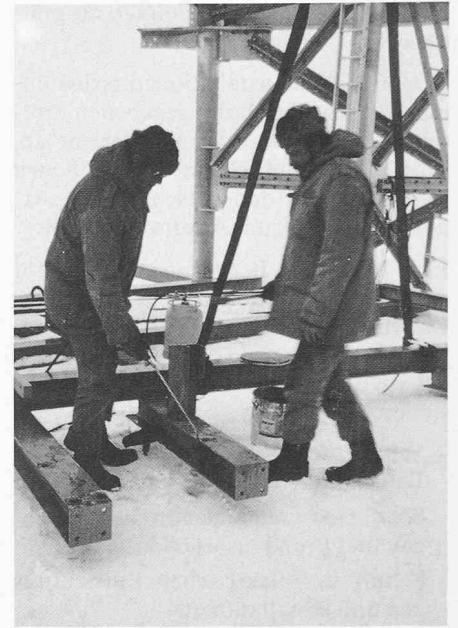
Stahlbaumonteur mit Windjacke und Pelzmütze (statt Bauhelm)
